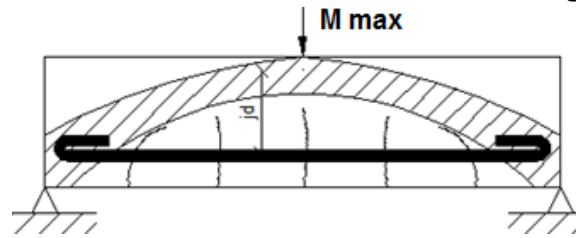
2 Arco atirantado en una viga con refuerzo liso a la tracción
